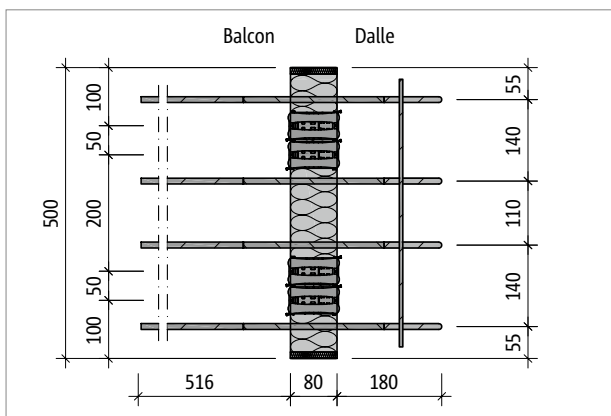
Schöck Isokorb® T Type Q-E-W-V5-L500 : Plan de base du produit
